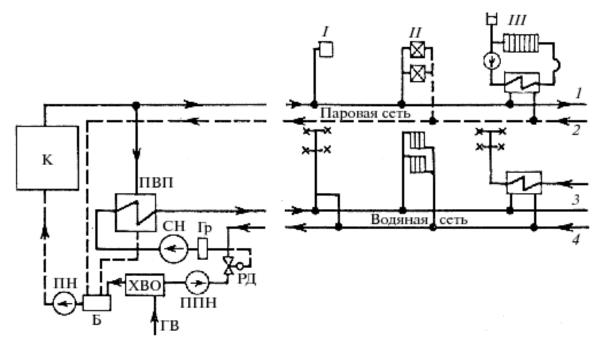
Схема теплоснабжения от паровой промышленной котельной: 1 – пар; 2 – конденсат: 3 – горячий трубопровод; 4 – обратный трубопровод; ПН – питательный насос; Б – конденсационный бак: ПВП – пароводяной подогреватель
